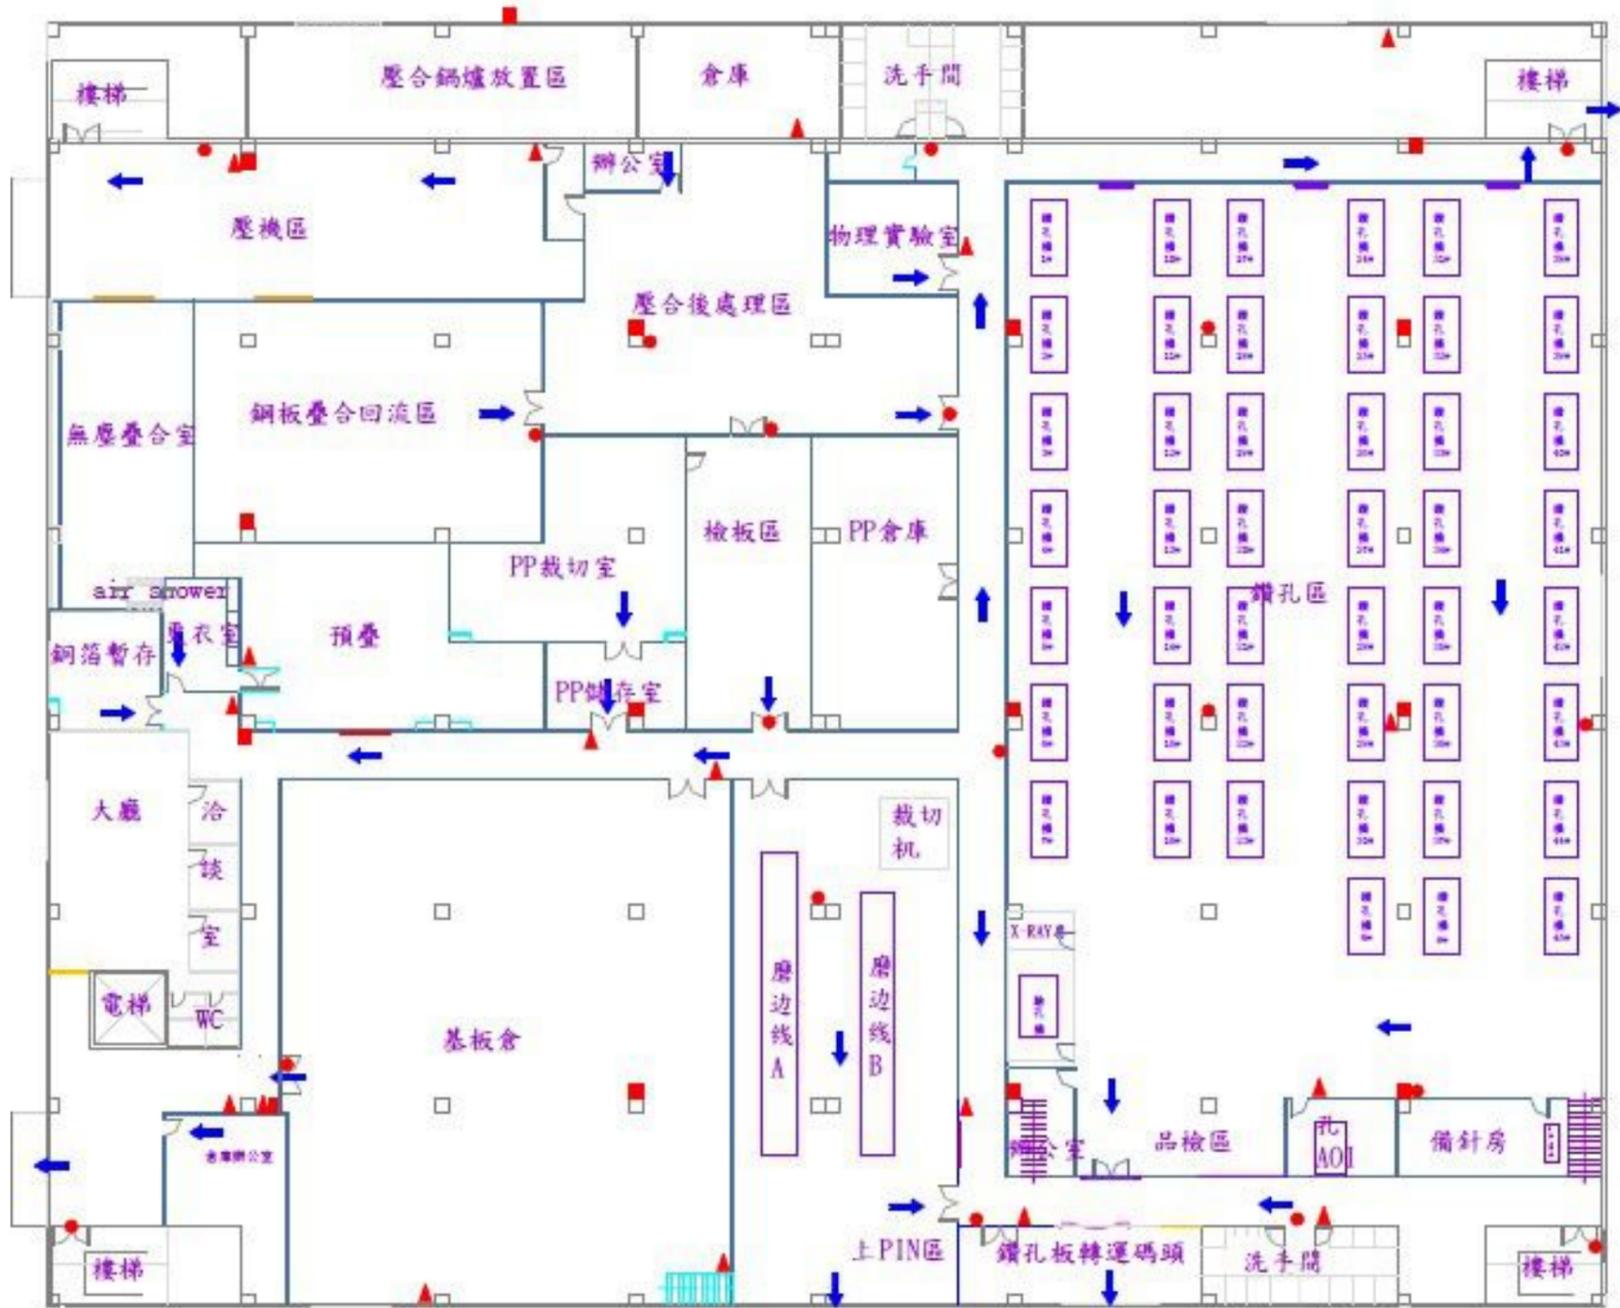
建设项目车间（二厂）一楼平面布置图
